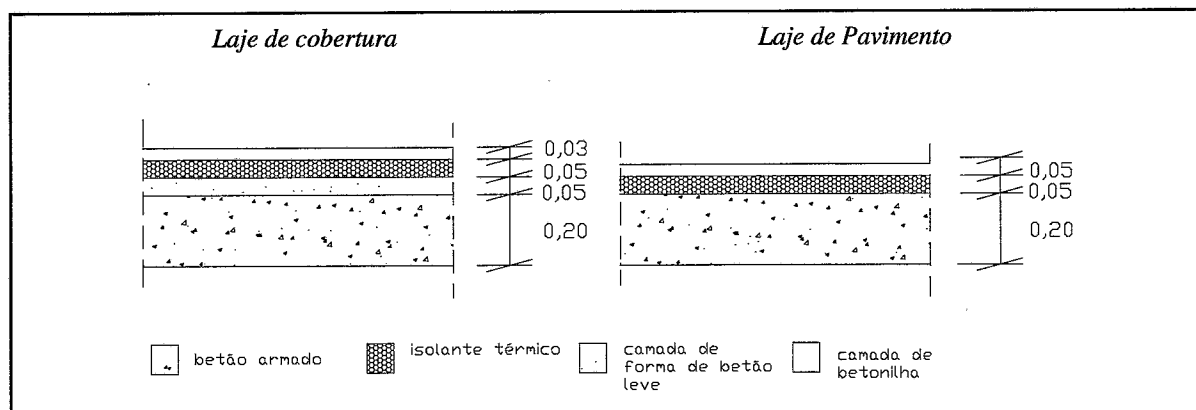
Soluções construtivas da laje de cobertura e da laje de pavimento utilizada no cálculo numérico
